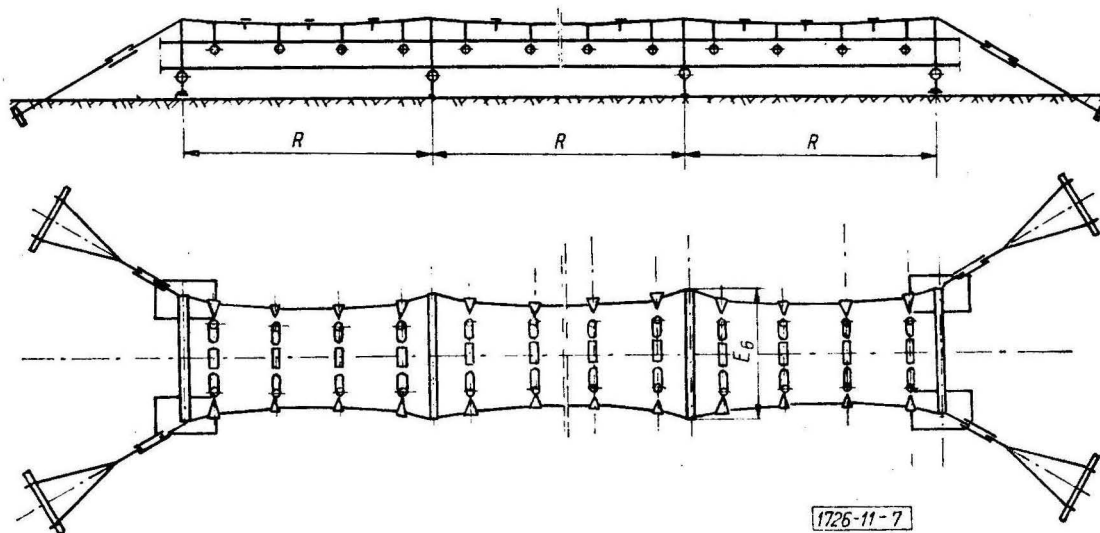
Człon linowy przesuwany. Konstrukcja przykładowa
